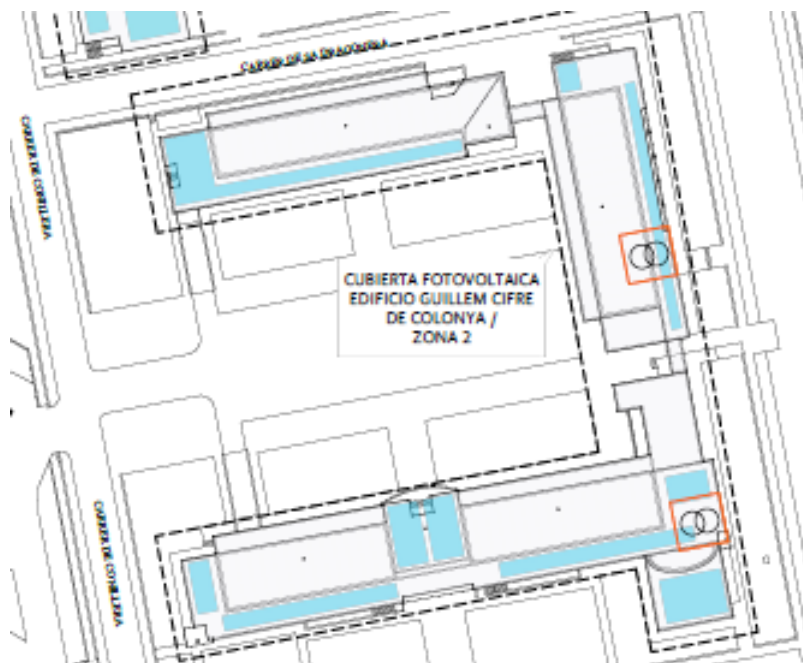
Disposición de placas fotovoltaicas en la cubierta del edificio Guillem Cifre de Colonya
